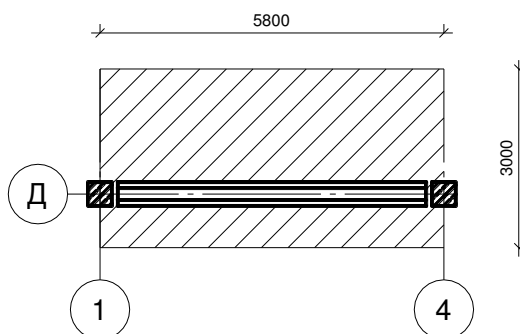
Схема для сбора нагрузок на ригель
